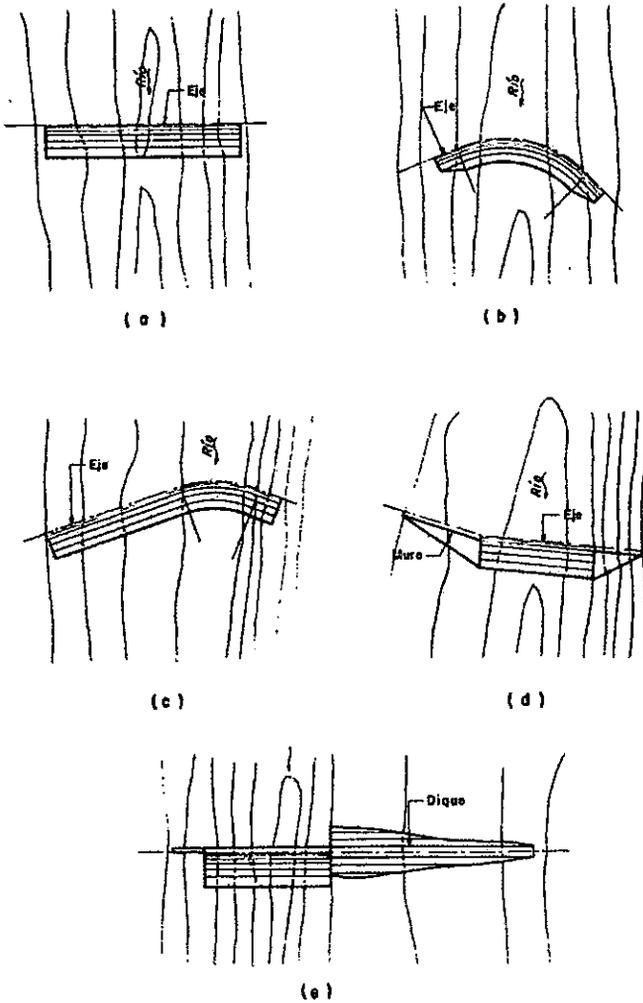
Tipos de presas derivadoras por su eje en planta
